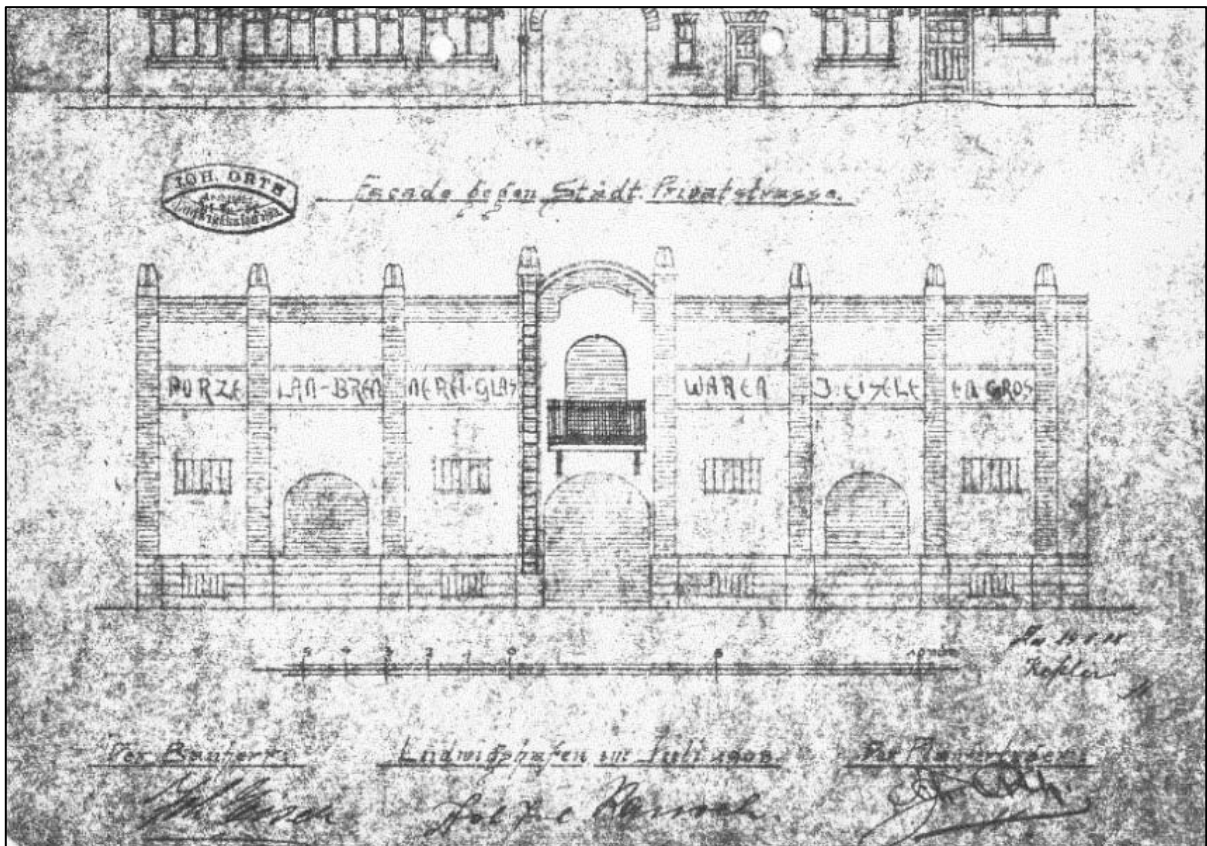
Fassade der Lagerhalle, „Facade gegen Städt. Privatstrasse“, Humboldtstraße 63 (Privatarchiv Eisele-Metz/Baupläne).
